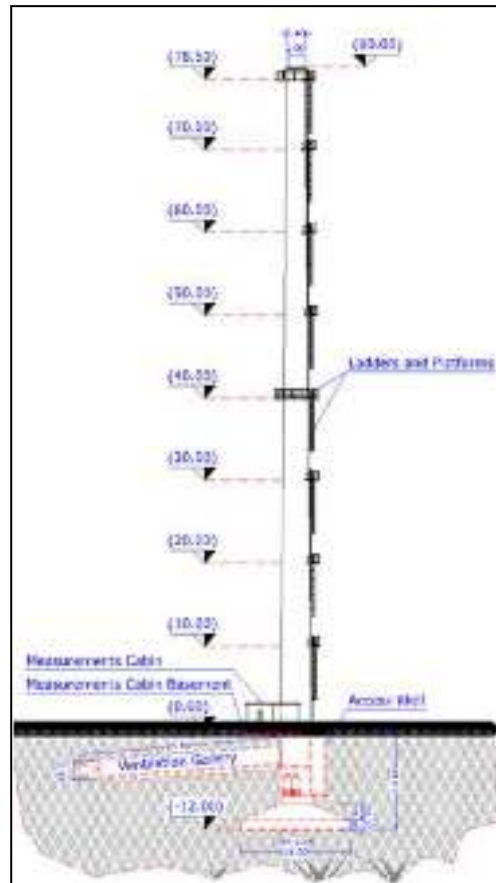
Camino di ventilazione (Edificio 88) – Sezione frontale
